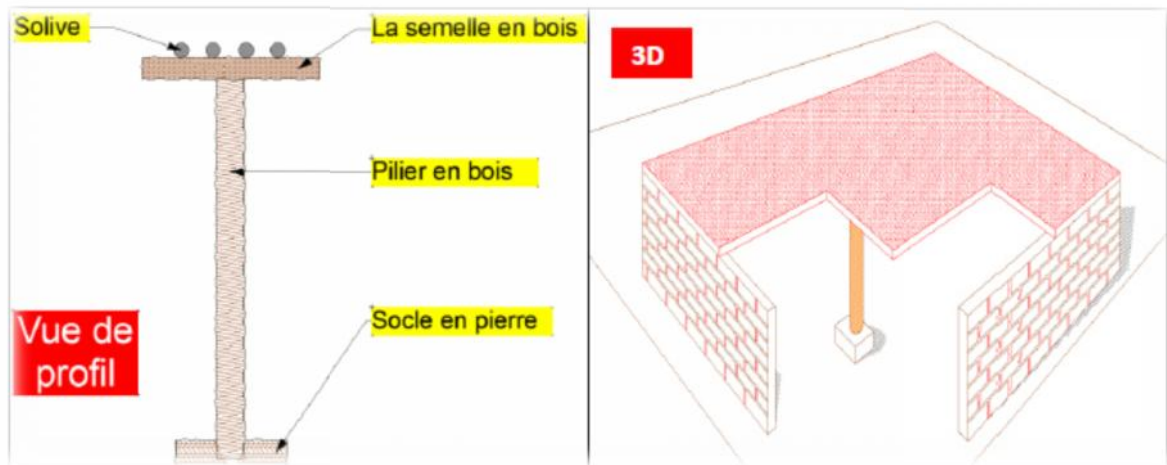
Le poteau dans la maison traditionnelle. Source : Auteur (2016)
